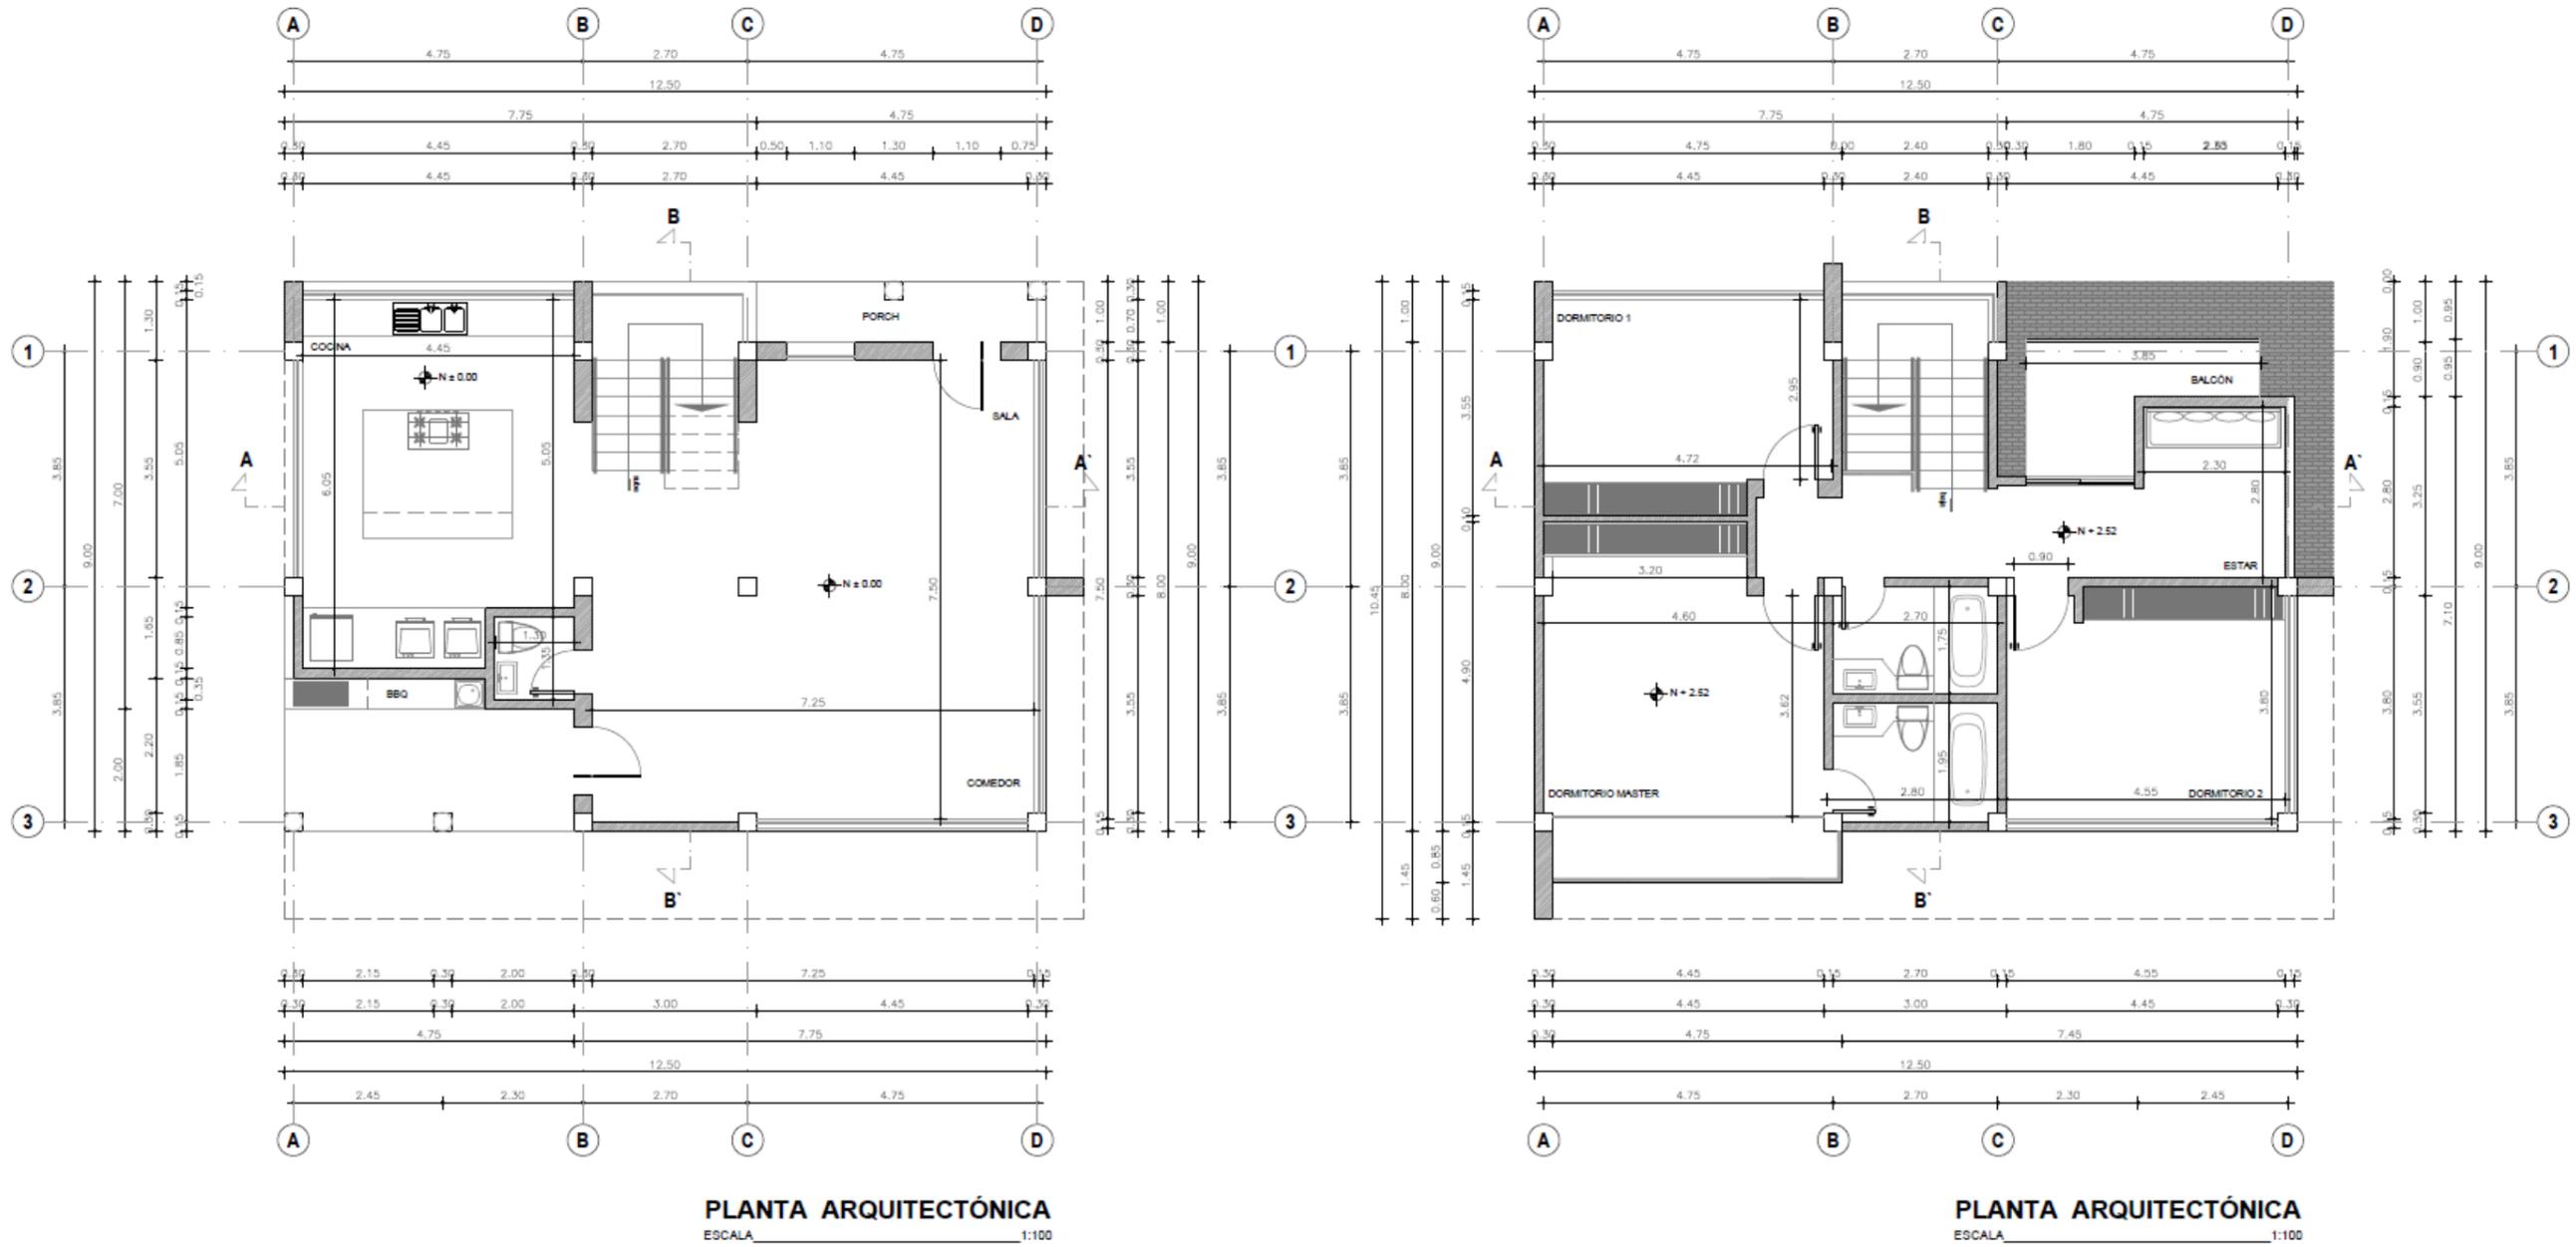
Planta arquitectónica Casas 20 B y 20 C
